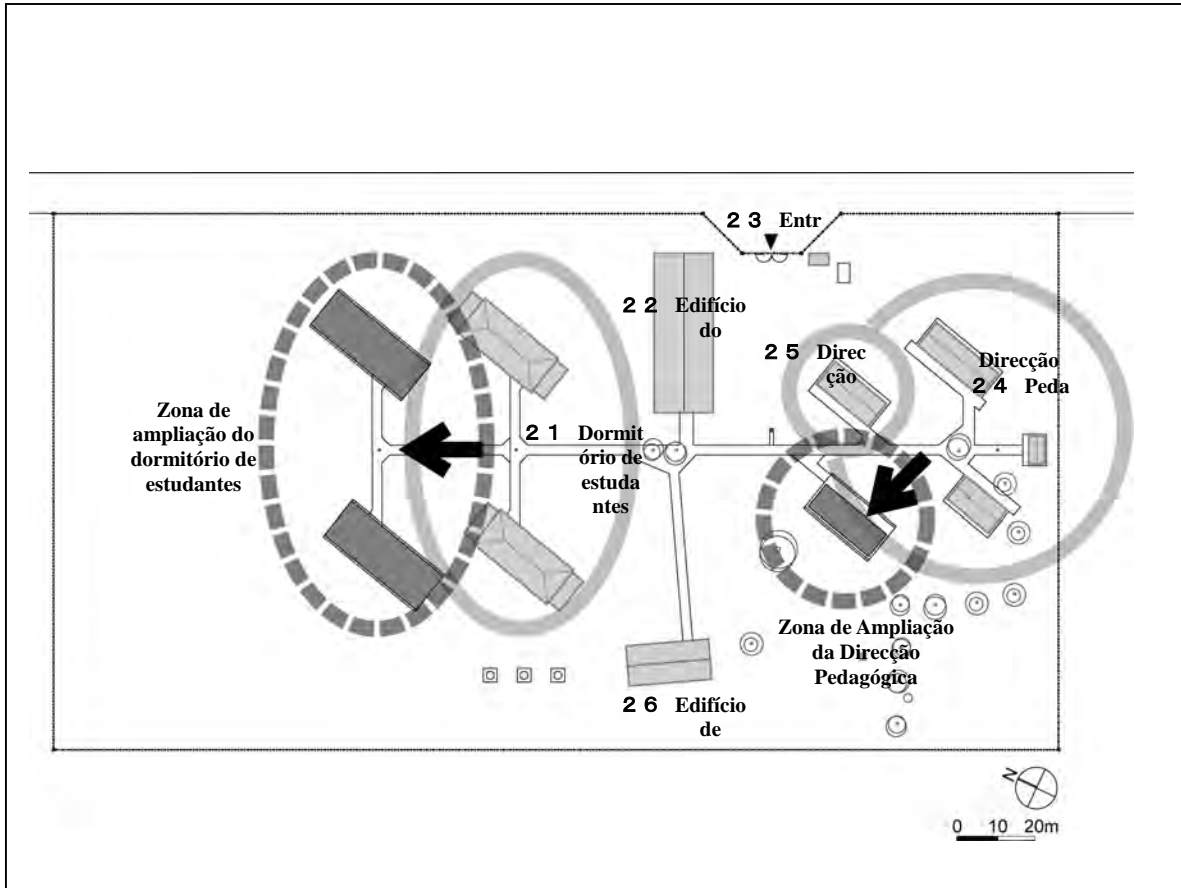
Plano do terreno e da disposição das instalações do CFS Nhamatanda
